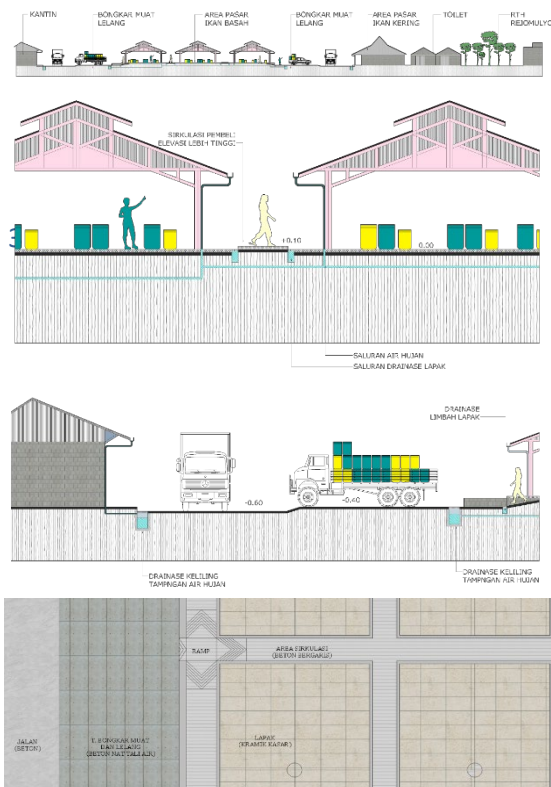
Lapak ikan bandung dengan sistem drainase
